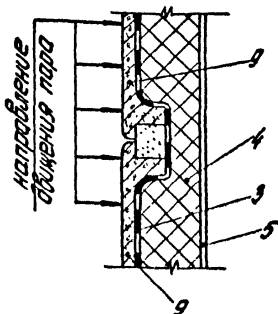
Притыкание междуэтажных перекрытий к наружным стенам.
